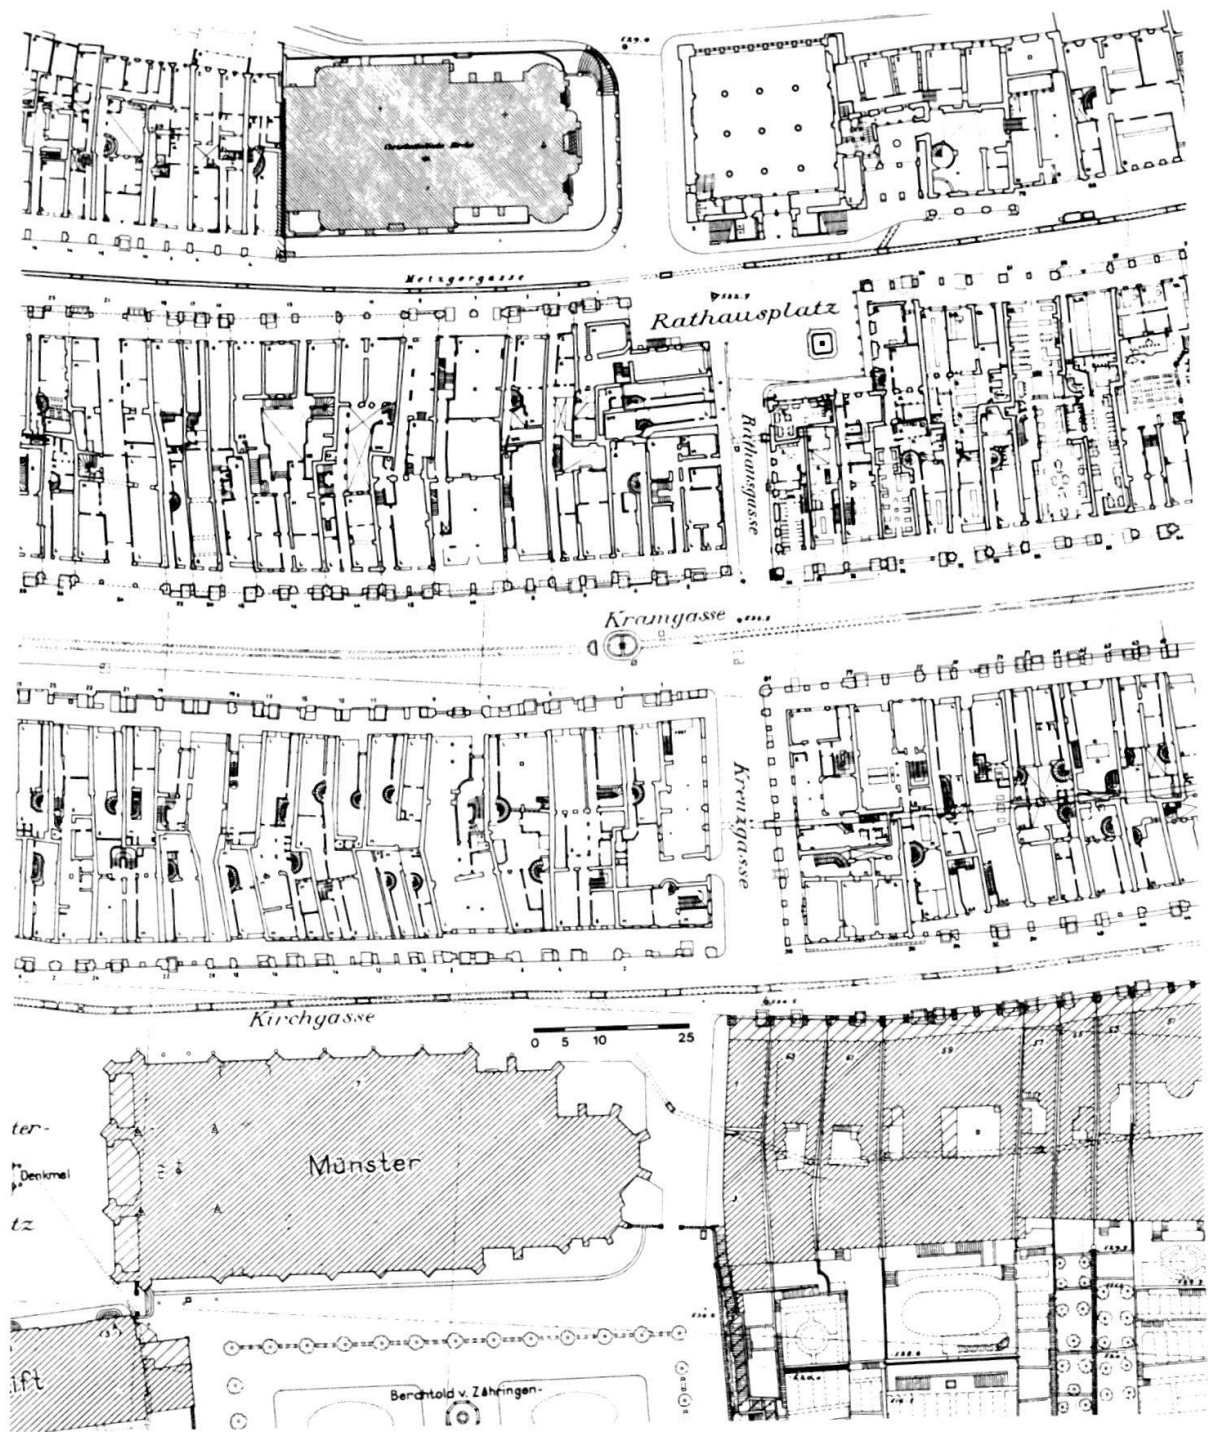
BERN, Altstadtanierung II. Etappe, Gesamtplan, Bestand Erdgeschoss, Aufnahmen des TAD, zusammengestellt durch das Städtische Hochbauamt Bern, 1949.
